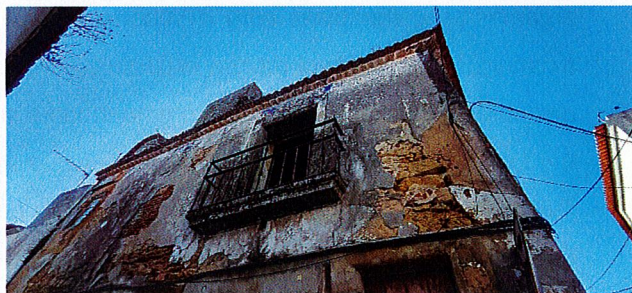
Vista sobre a fachada confinante com a Tv. do Arrabalde
